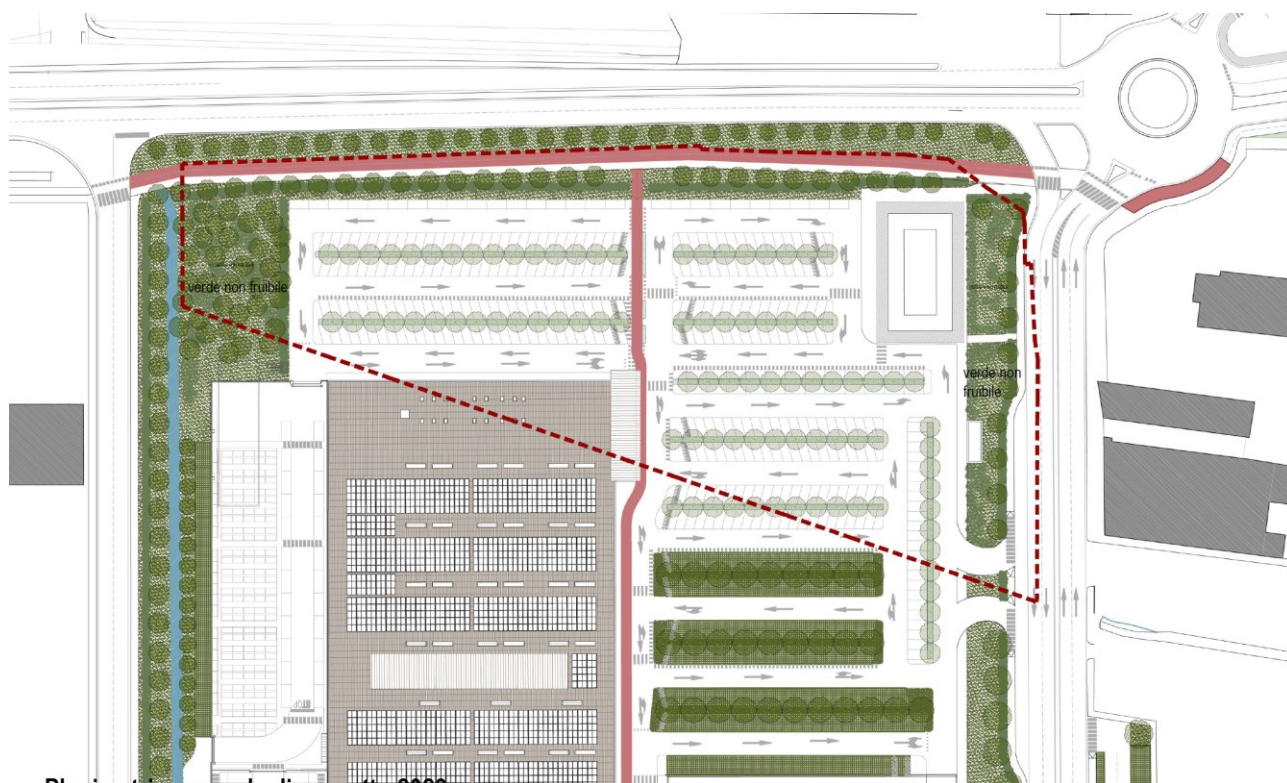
Planimetria generale di progetto – Nuova configurazione progettuale
